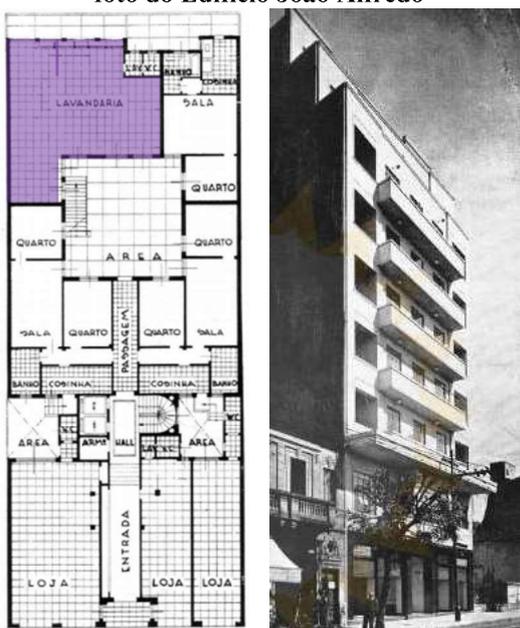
Planta tipo de um edifício de apartamentos (1930) no Rio de Janeiro
